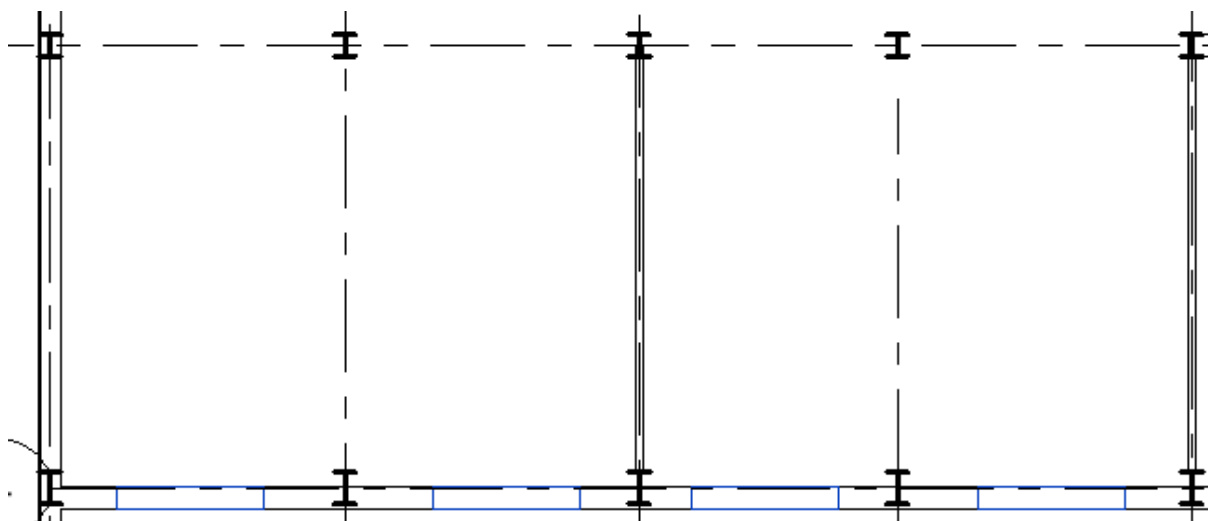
Vista en planta para aumento de luz natural en mesas de trabajo y almacén
